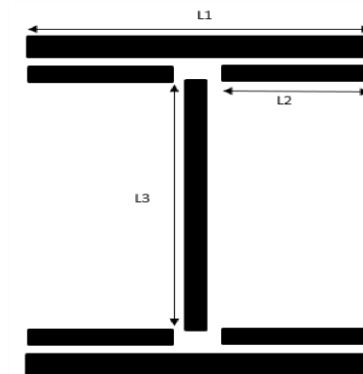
Assemblage soudé poutre – platine.
